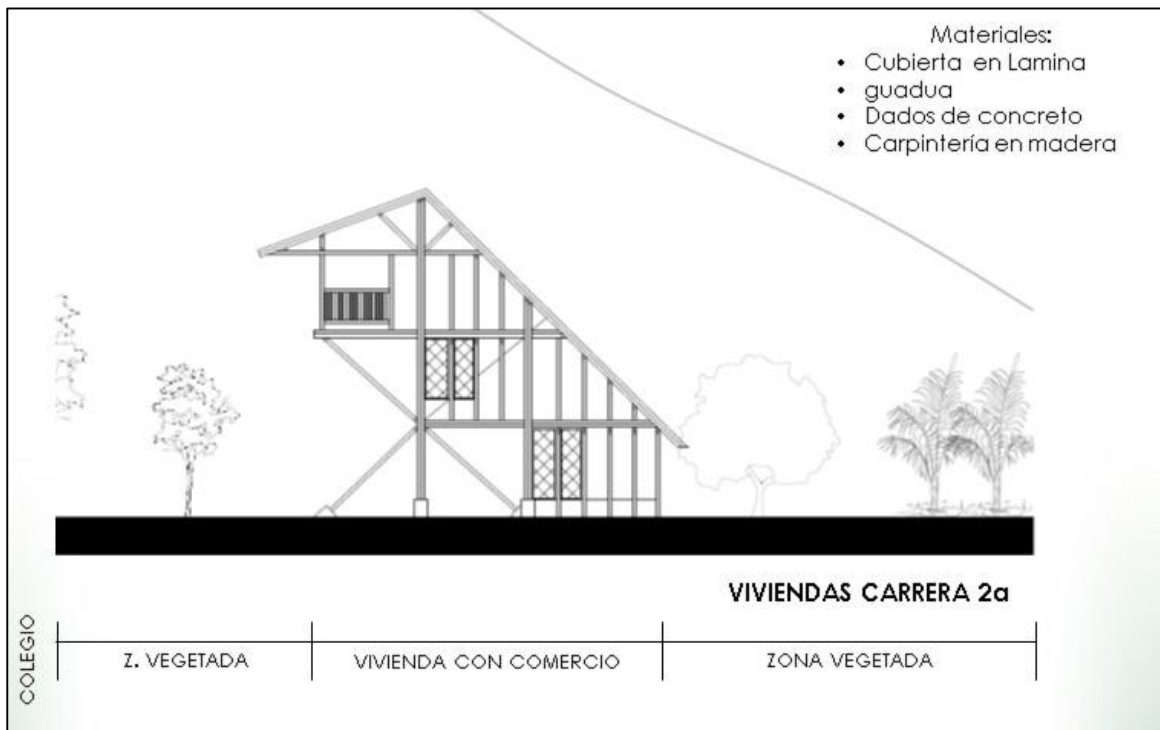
Levantamiento perfil calle auxiliar y carrera 2
